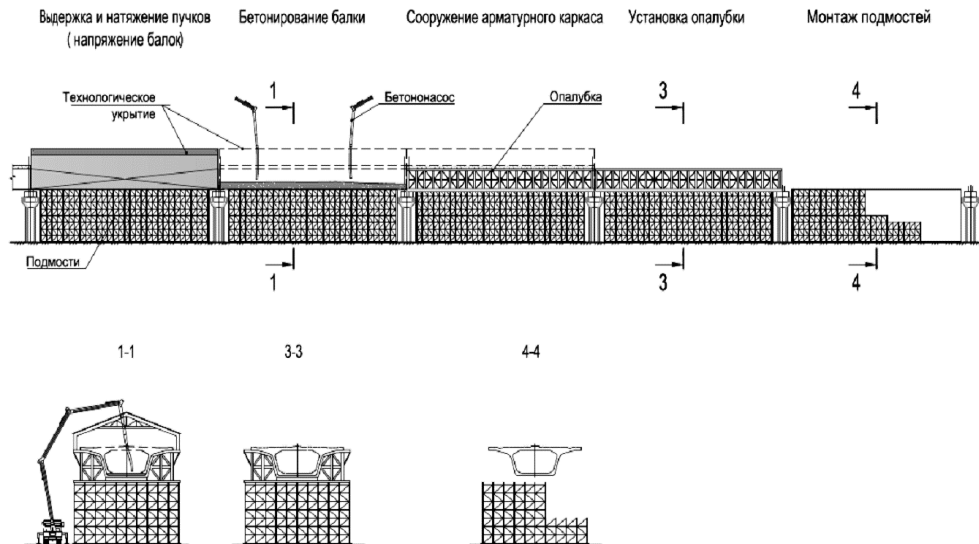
Изготовление железобетонных пролетных строений на сплошных подмостях
